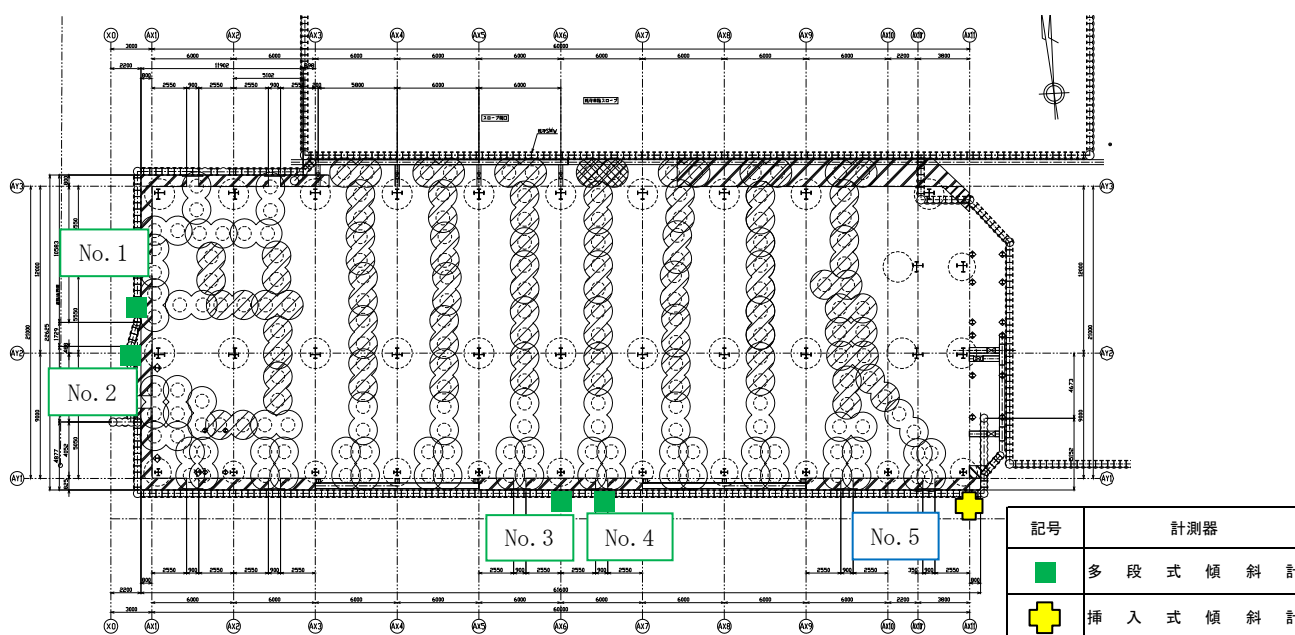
深層地盤改良工法の範囲平面図及び傾斜計による測定位置図
